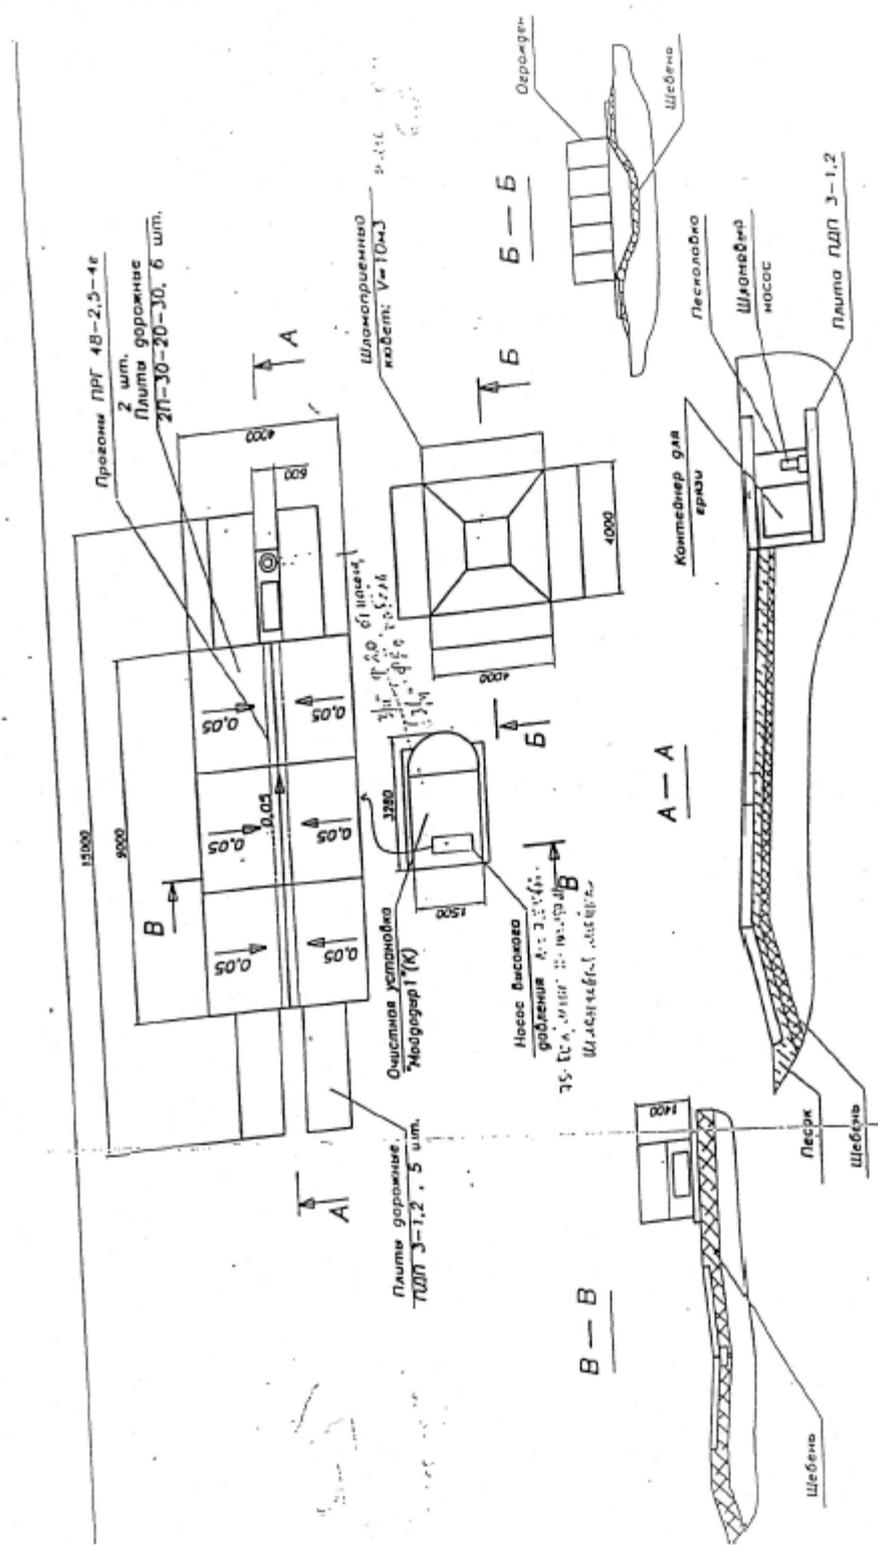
Схема устройства площадки и расположения теплового оборудования.
